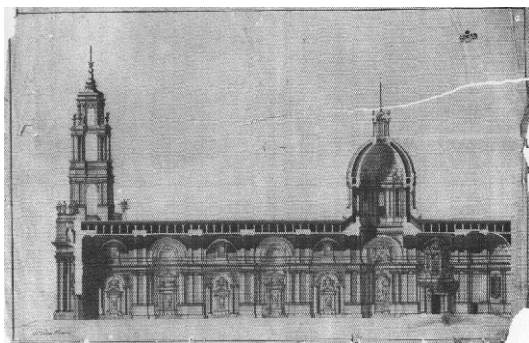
Felipe Fontana: *Templo de tres naves adornado de orden corintio*" (1776) Consta de tres láminas: media planta, fachada y sección longitudinal. Técnica: Tinta, lavado y color
